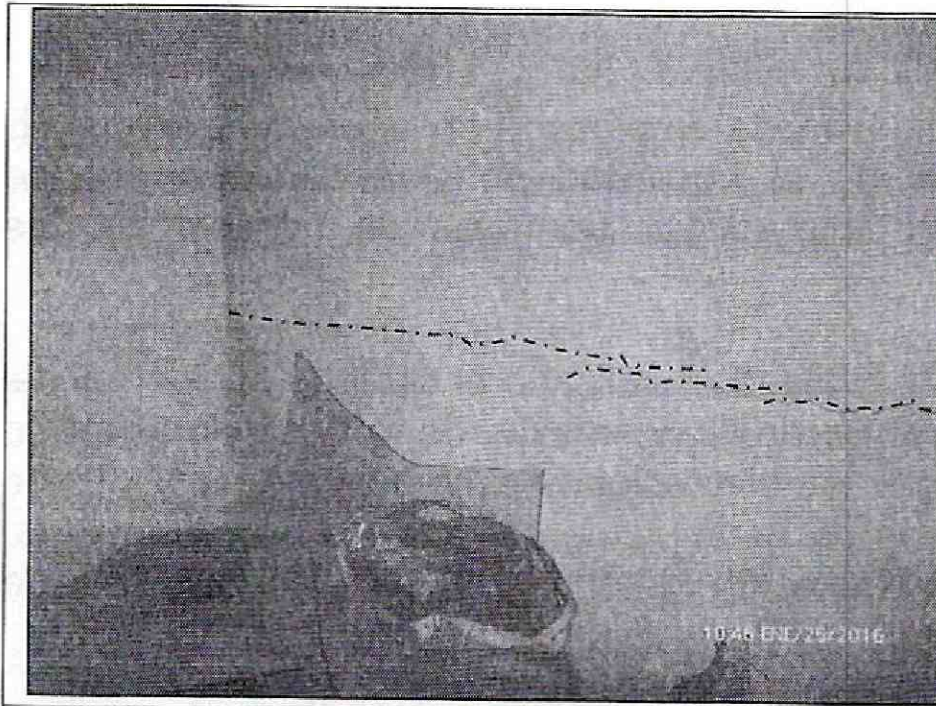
Vista del muro de fachada del segundo nivel, donde se evidencia una fisura de tendencia horizontal en la trayectoria donde se presenta la unión de la placa de entrepiso y el muro en mampostería de la fachada.
